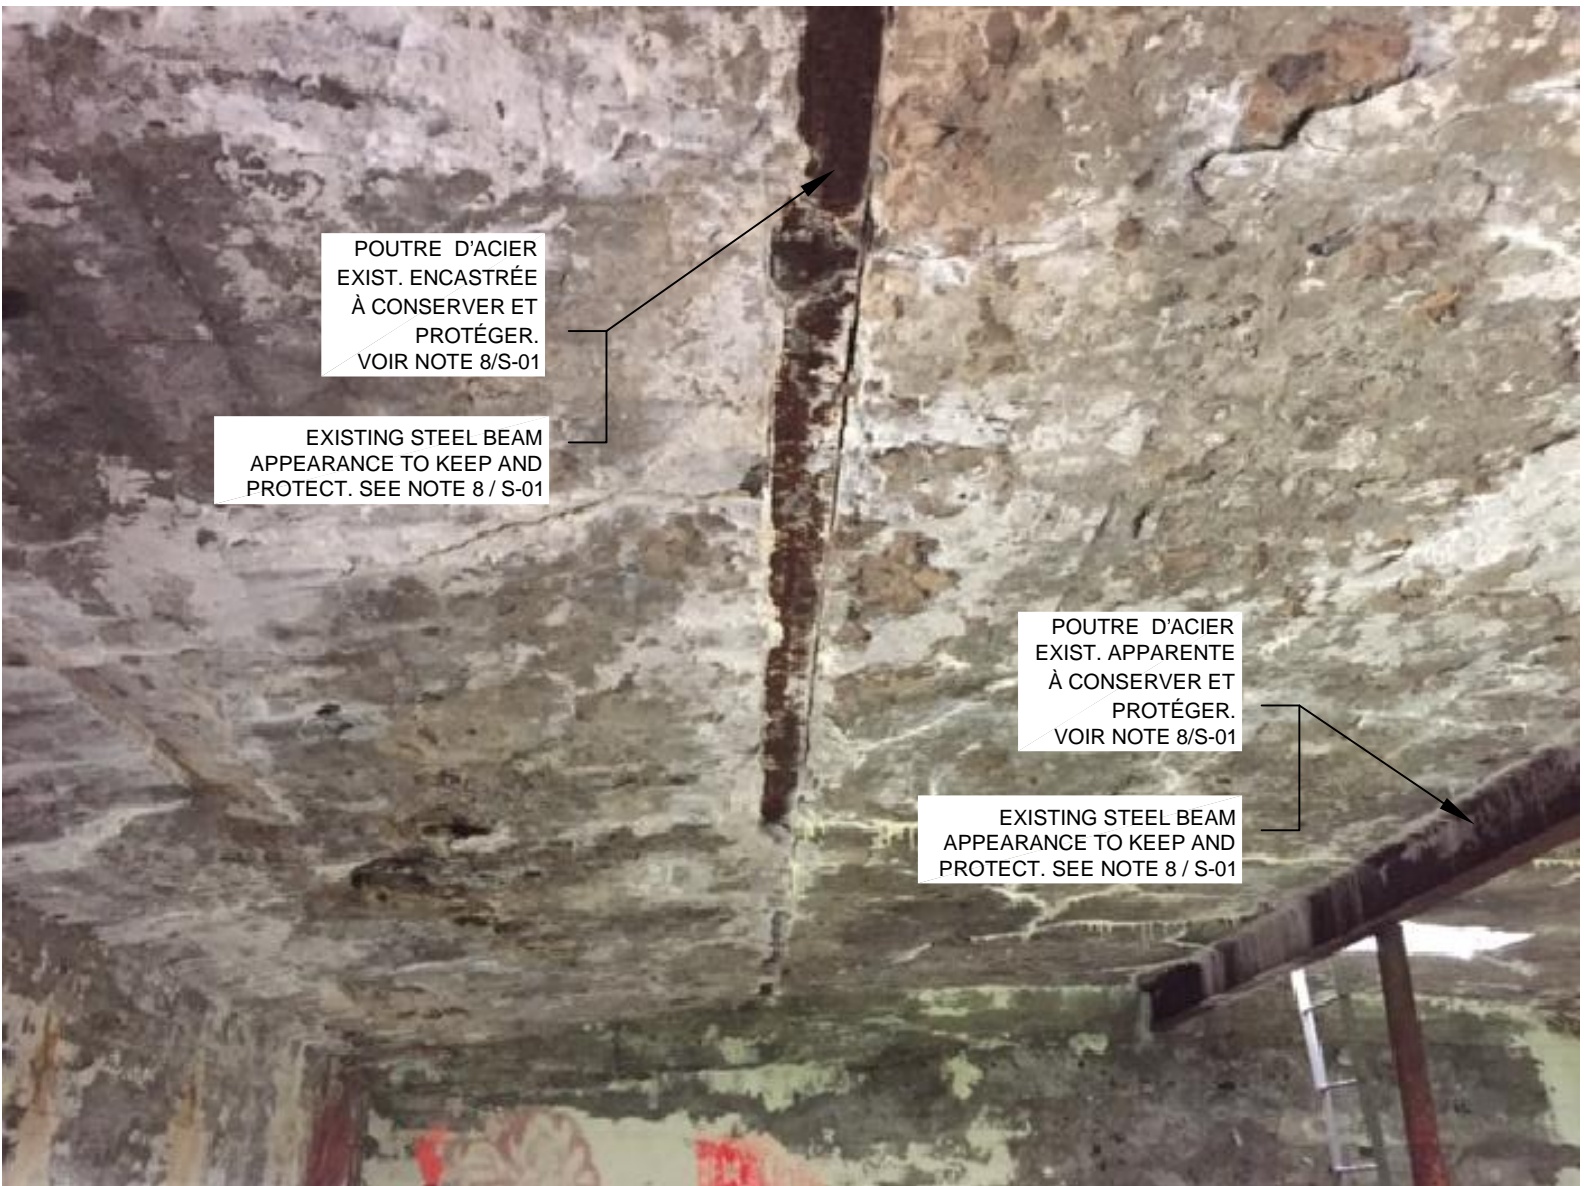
POUTRES EXISTANTES / EXISTING BEAMS
